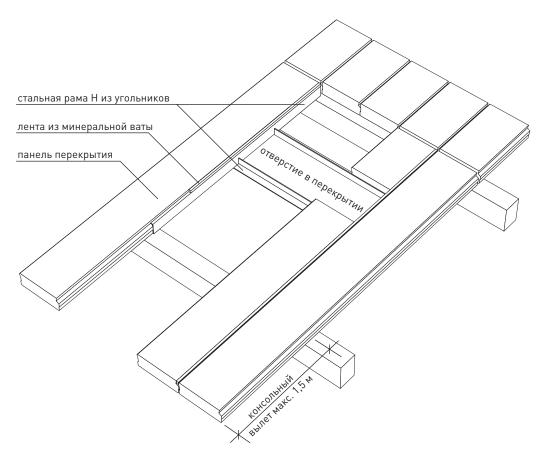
Применение панелей перекрытия YTONG из армированного автоклавного газобетона
